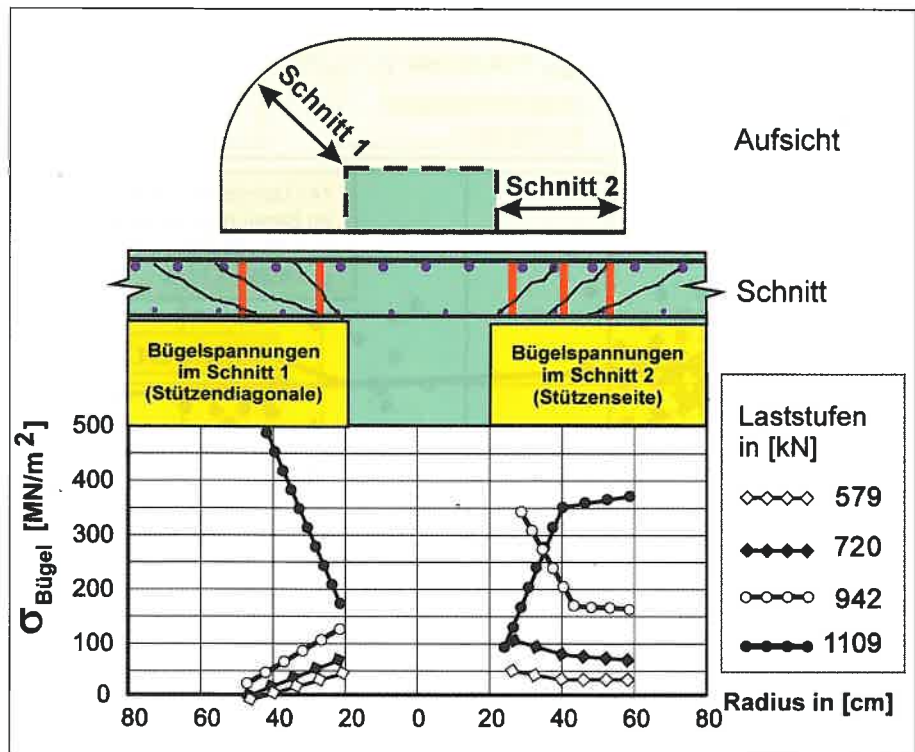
Bügelbeanspruchung des Versuchskörpers P2-II (mit konventionellen Bügeln)
